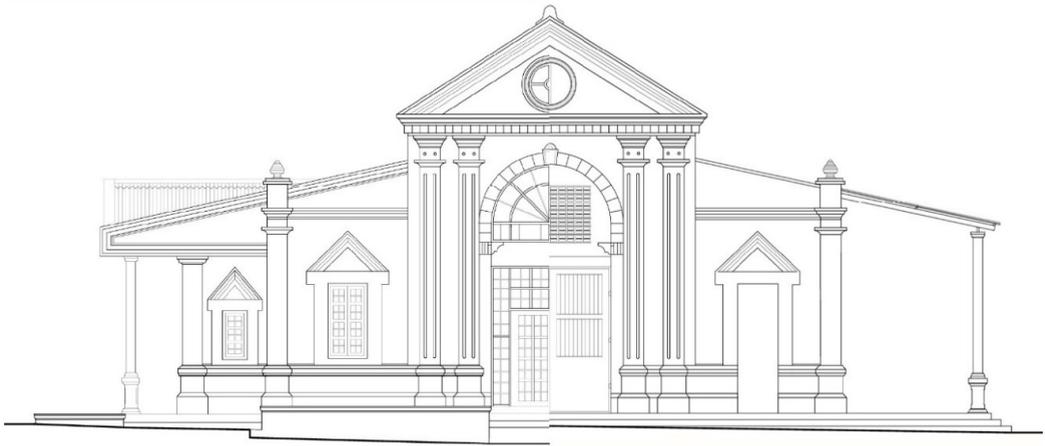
Fachada Sureste. Confrontación de la fachada del Mercado de Cereté, antes y después de la intervención. Lado derecho fachada original, lado izquierdo fachada rehabilitada. Elaboración M. López Lora, M. Leserri (2019).
